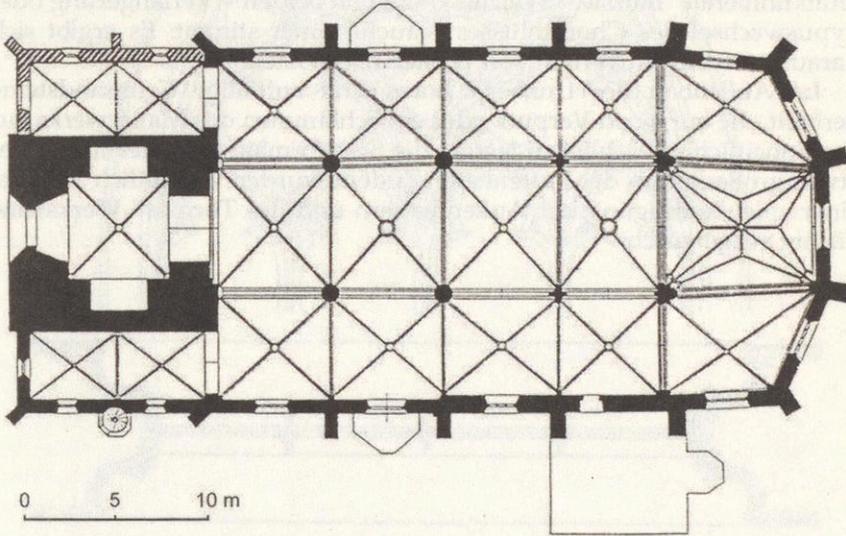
Stadtkirche St. Agatha Dorsten, Grundriss
